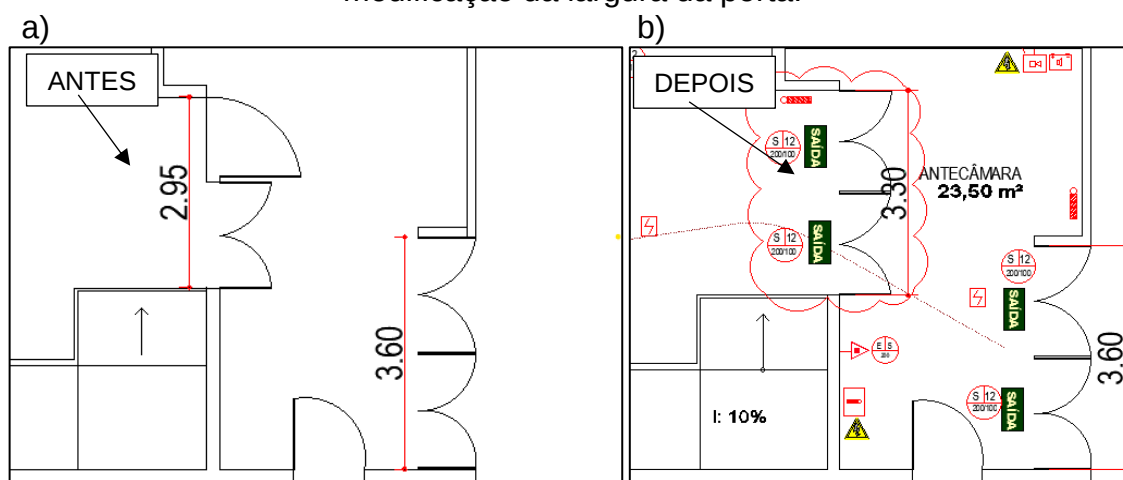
a) *Layout* da face direita antes da proposta de modificação; b) Proposta de modificação de *layout* para atendimento a norma vigente.
